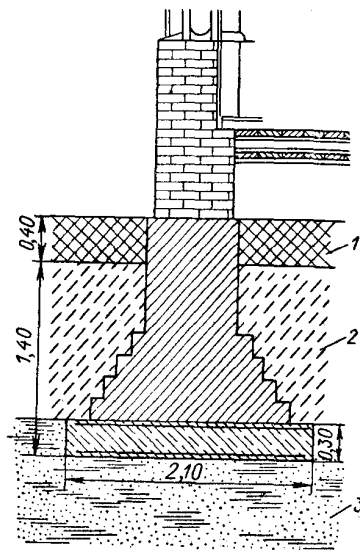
Фундамент, расположенный на пльвуне. В основании фундамента железобетонная подушка (по М. И. Евдокимову-Рокотовскому). 1 — подсыпка; 2 — суглинок; 3 — пльвун. Размеры приведены в метрах.
